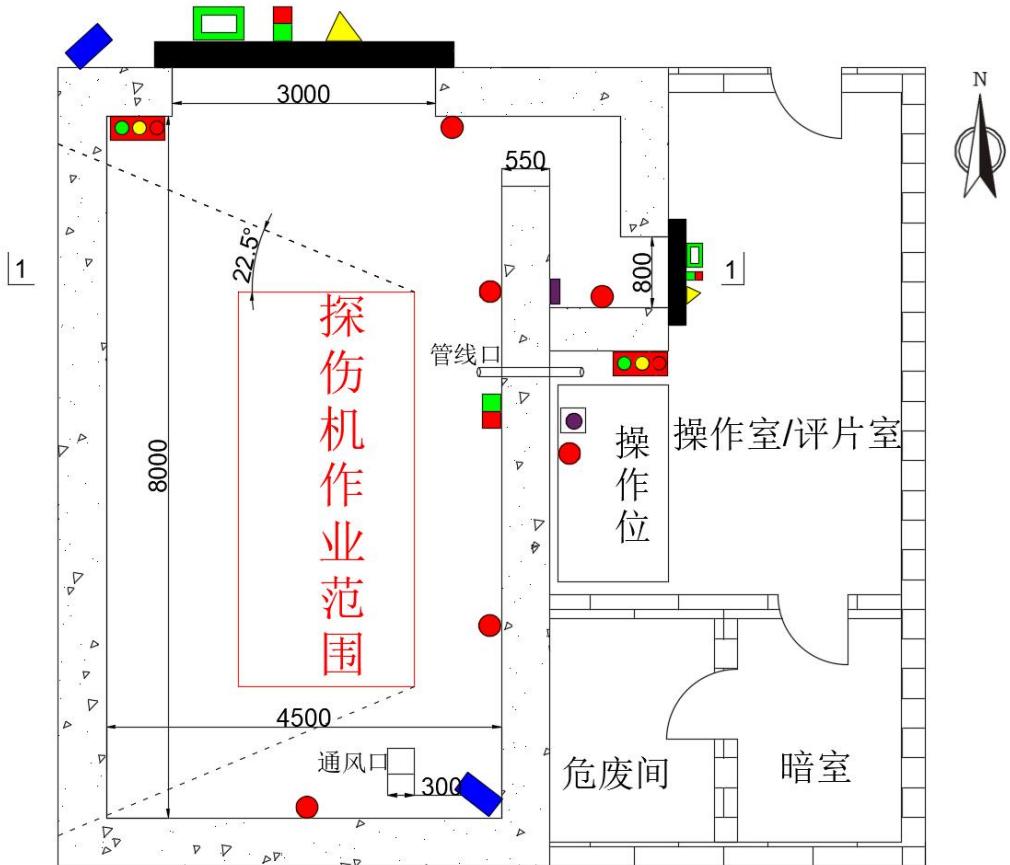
(a) 探伤机探伤作业范围平面图 (mm)
